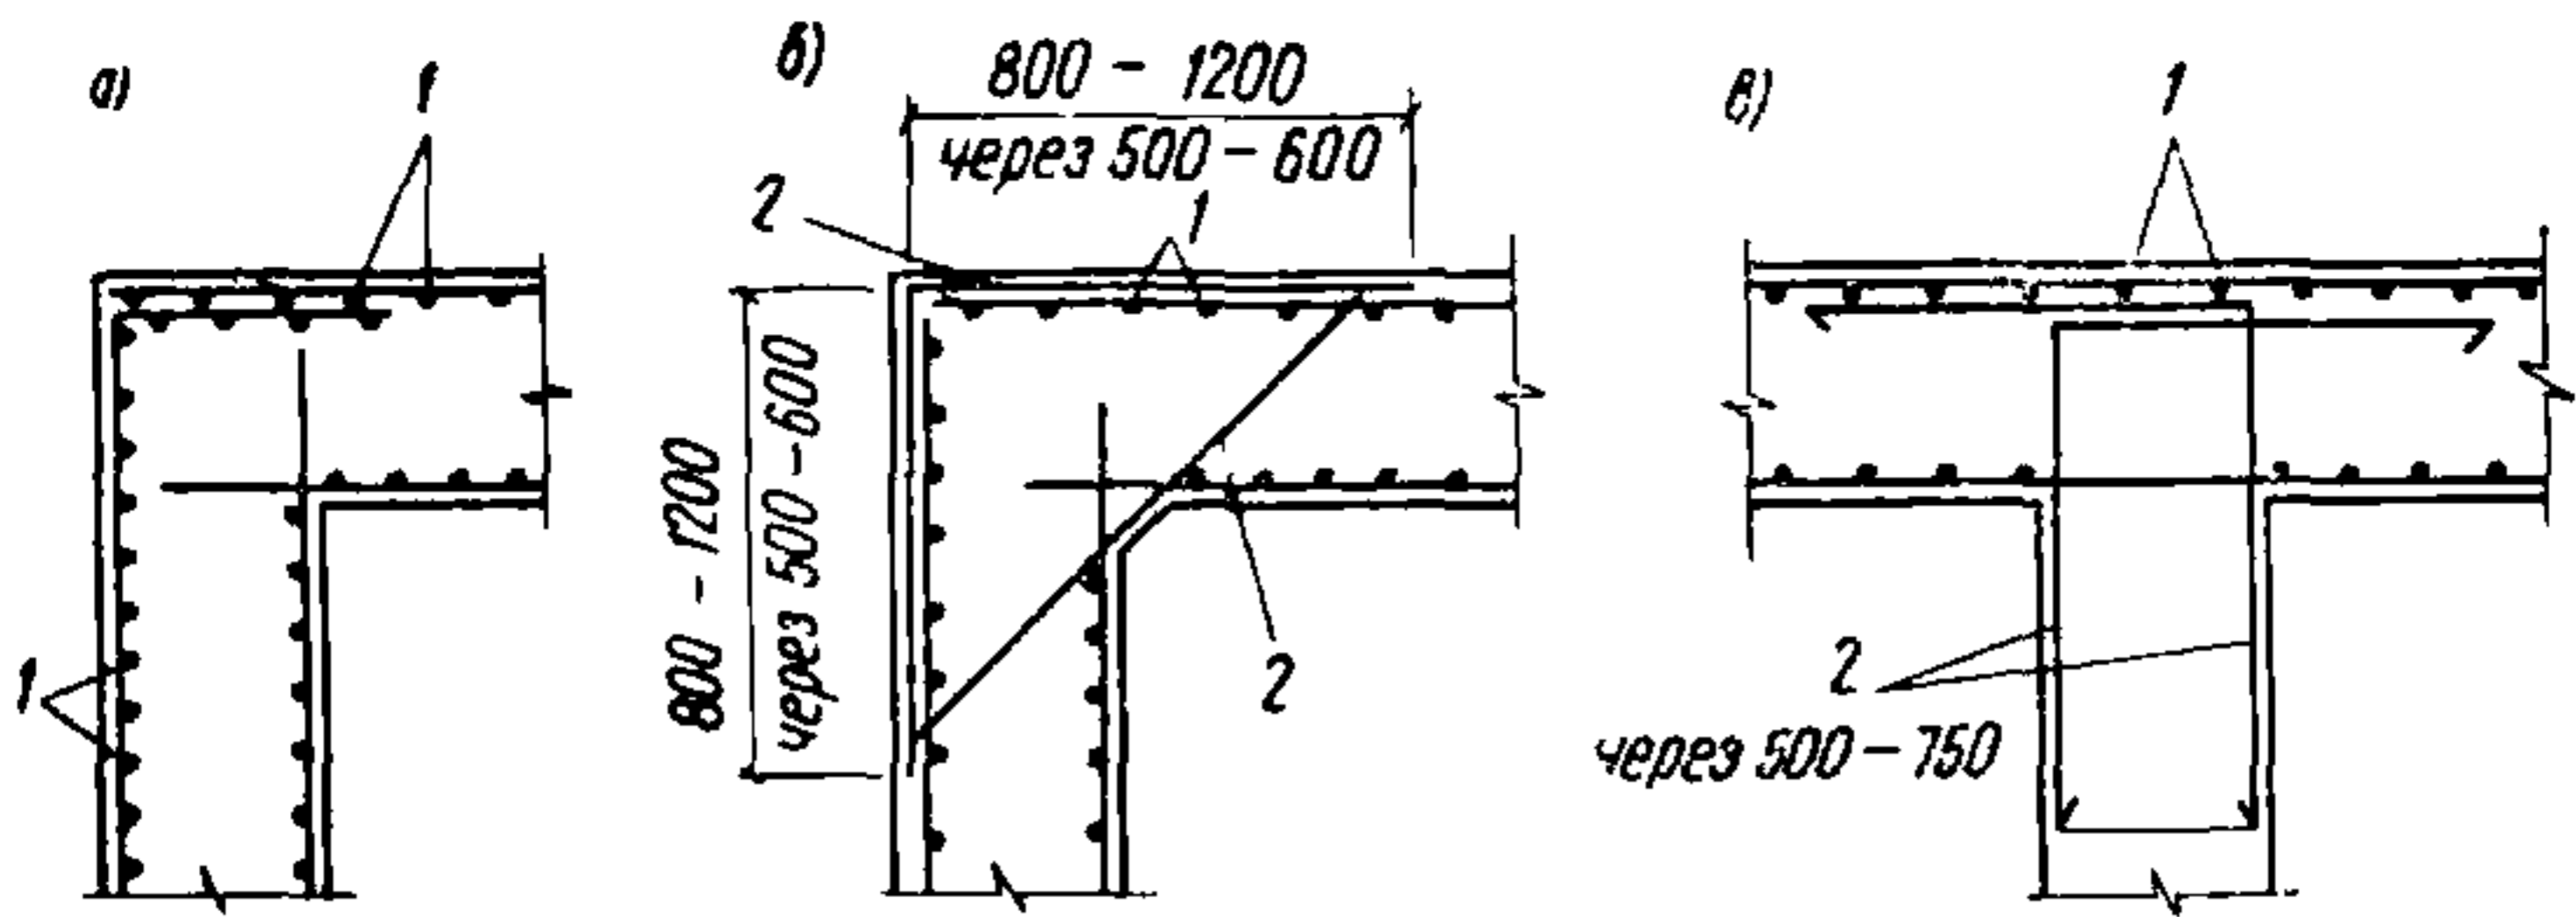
Детали армирования в местах сопряжения стен ядер жесткости
